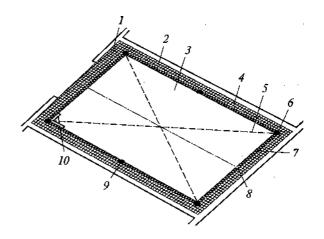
Разбивка покрытия пола и расположения маяков: 1 — прирубленные плитки; 2 — заделка; 3 — фон пола; 4, 6, 9 — реперный, фри промежуточный маяки; 5 — натянутый причальный шнур; 7 — фризовый ряд стальной штырь; 10 — угольник для разметки
